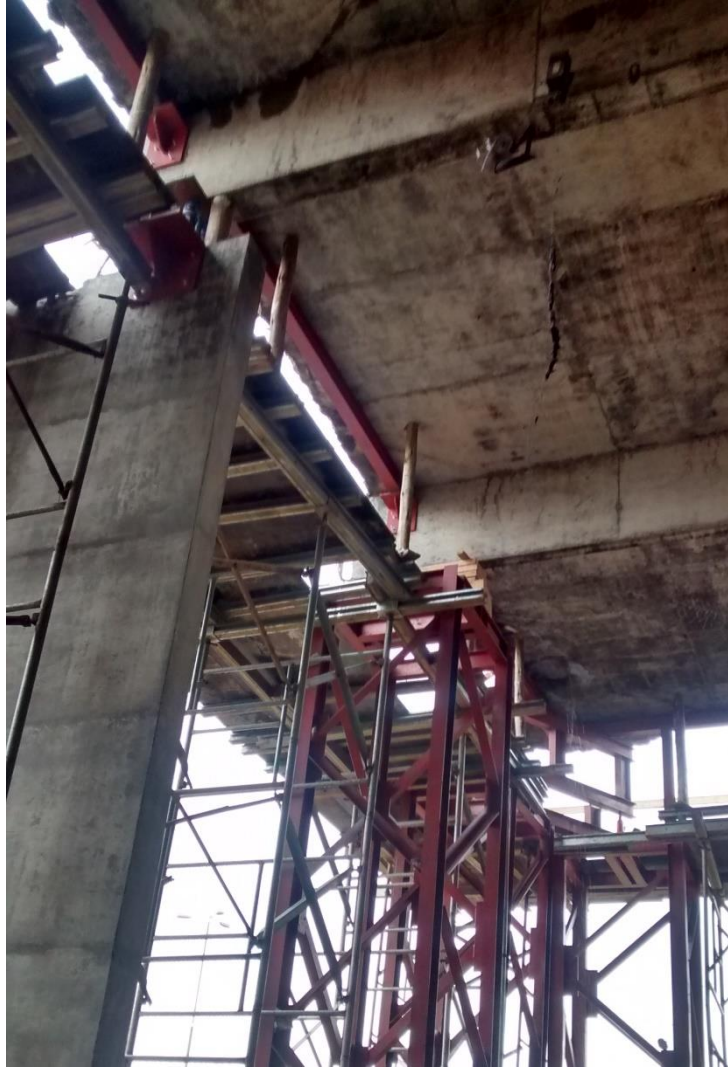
Vista do pavimento inferior da demolição das vigas de bordo. (Fonte: Dos autores 2016)
